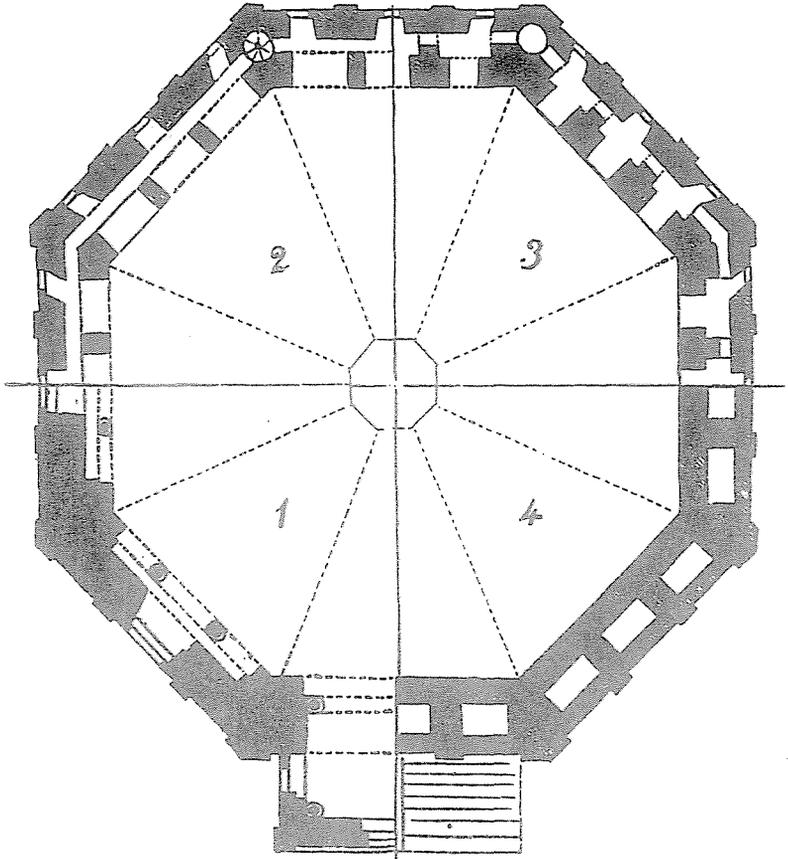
Grundriß des Battistero in Florenz. Nach Joseph Durm
